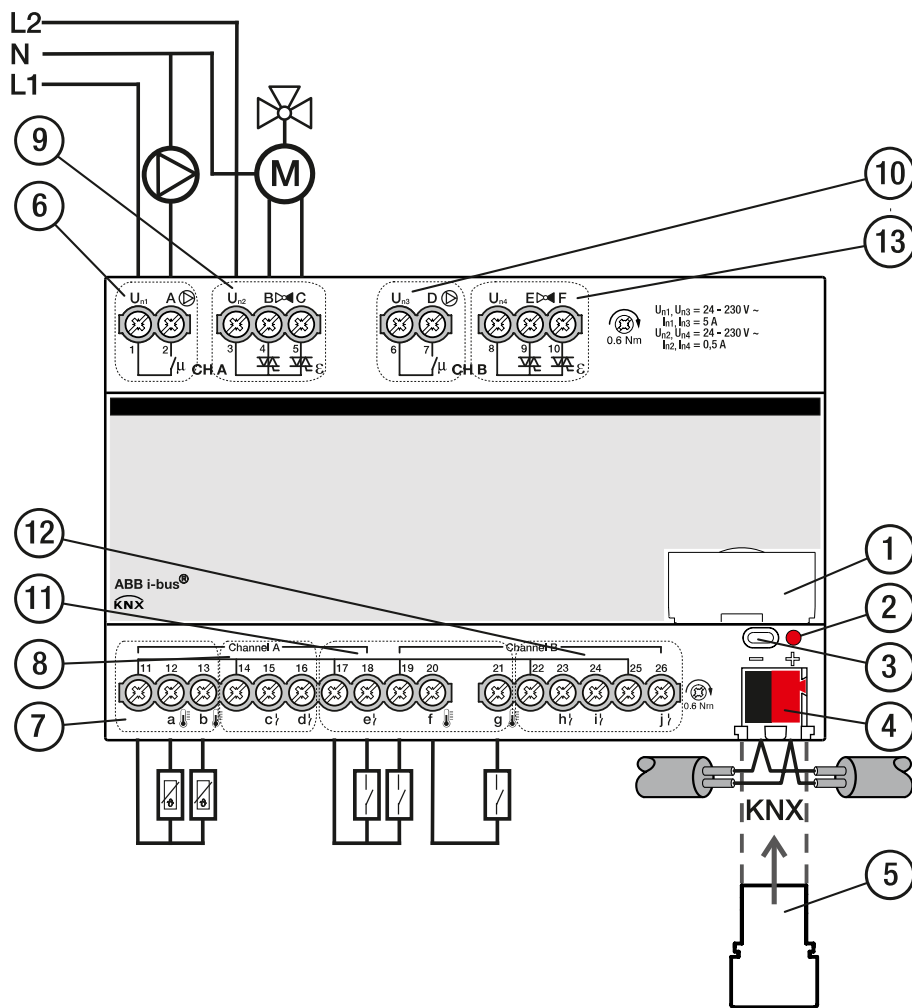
Schema di collegamento HCC/S 2.2.1.1
